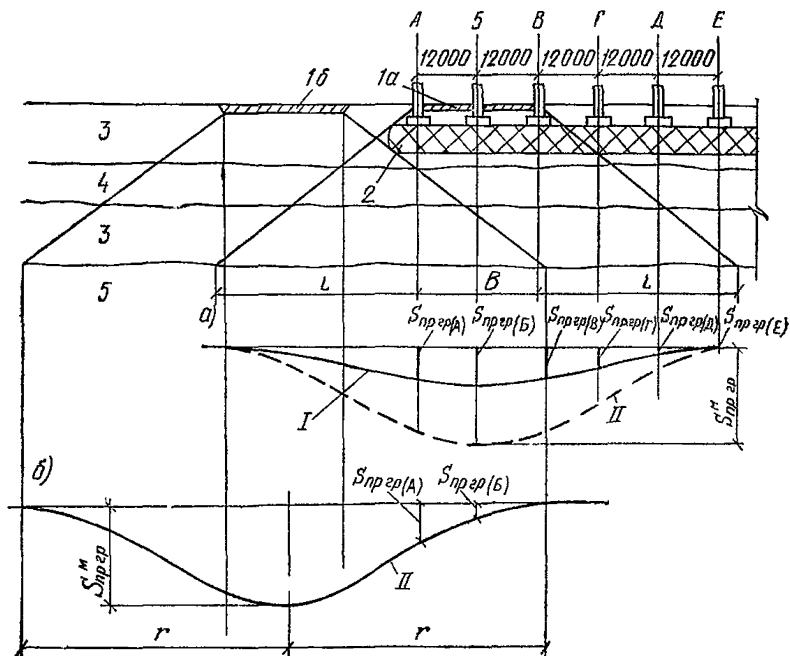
Расчетные схемы для примеров определения просадок фундаментов от собственного веса грунта при замачивании
